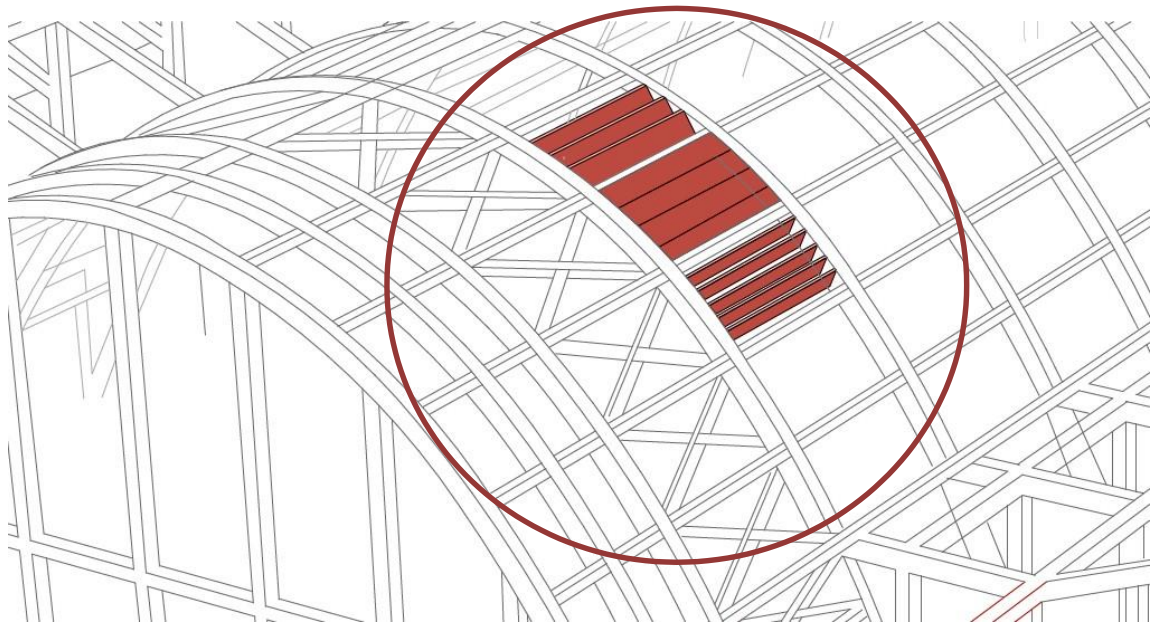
Esquema de cómo se aplicarían las celosías móviles en la estructura del mercado.
